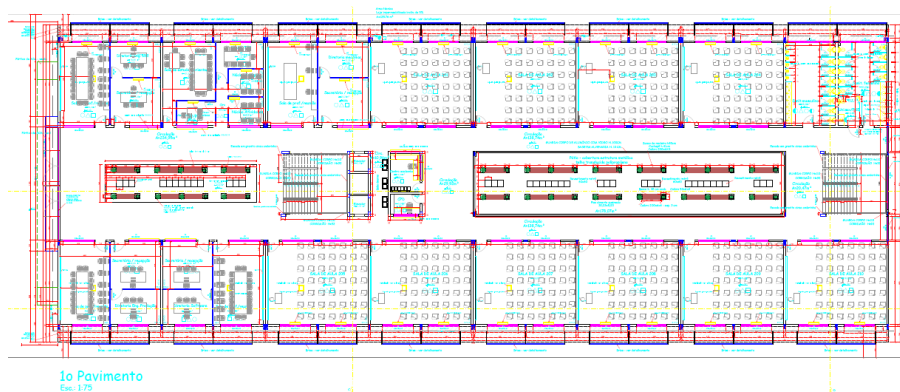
Projeto executivo, primeiro pavimento – Bloco VI.
